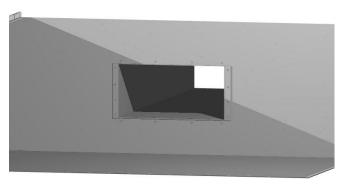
Chevauchement des embranchements de conduits (vue intérieure) <sup>2</sup>
